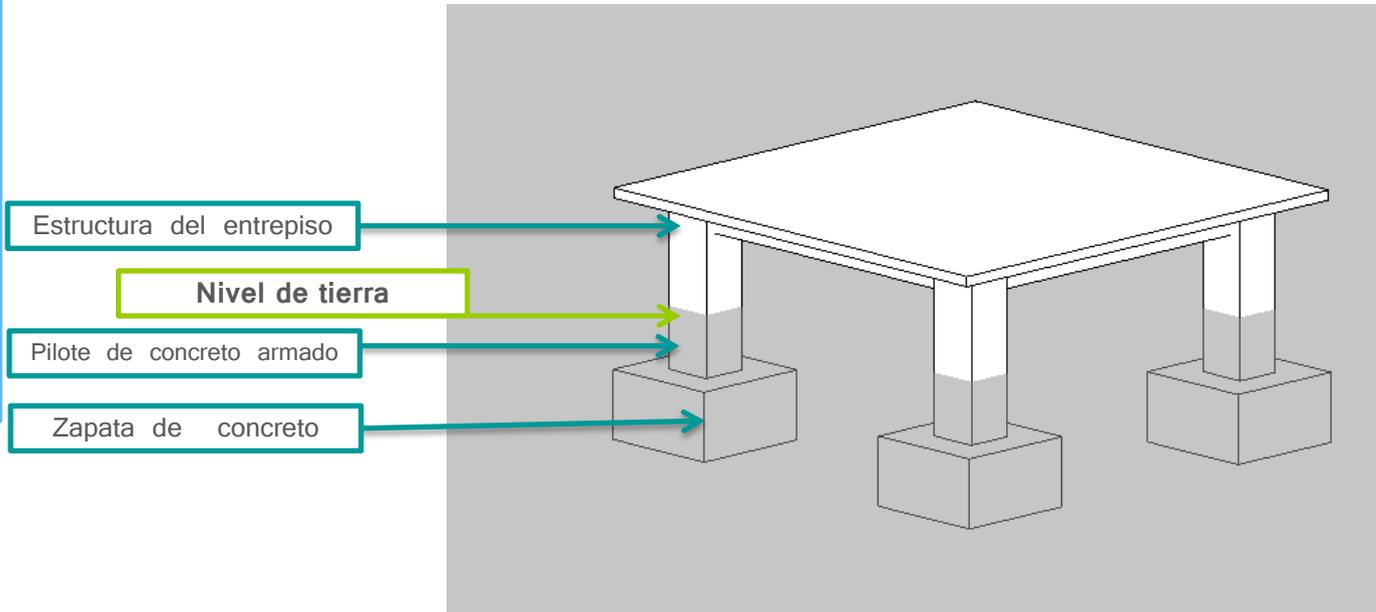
Cimientos sobre pilotes sin vigas de amarre
